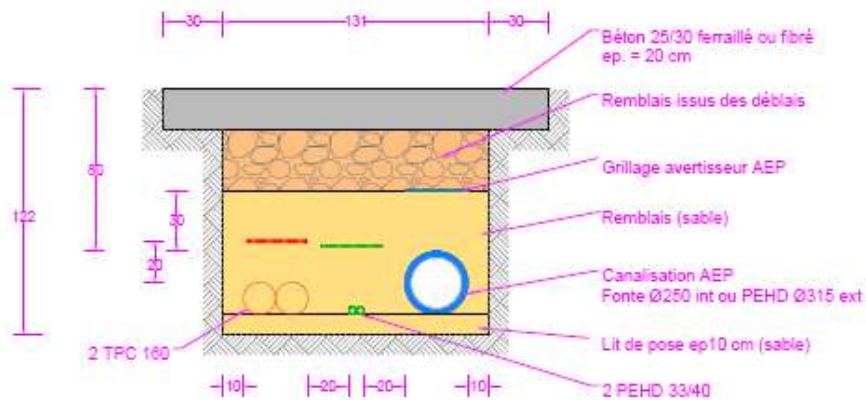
Coupe de principe au droit des passages d'ouvrages hydrauliques, de type buses ou dalots
